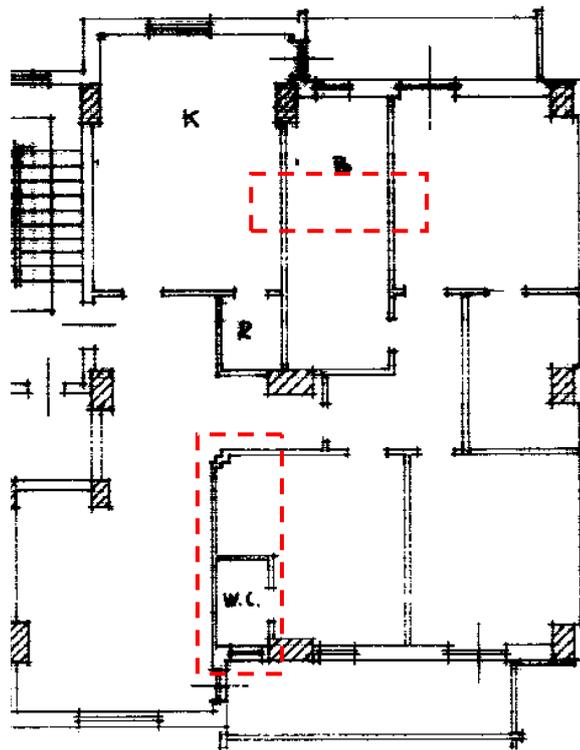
planimetria catastale in atti abbinata al sub 14 della p.lla 594 F.93
